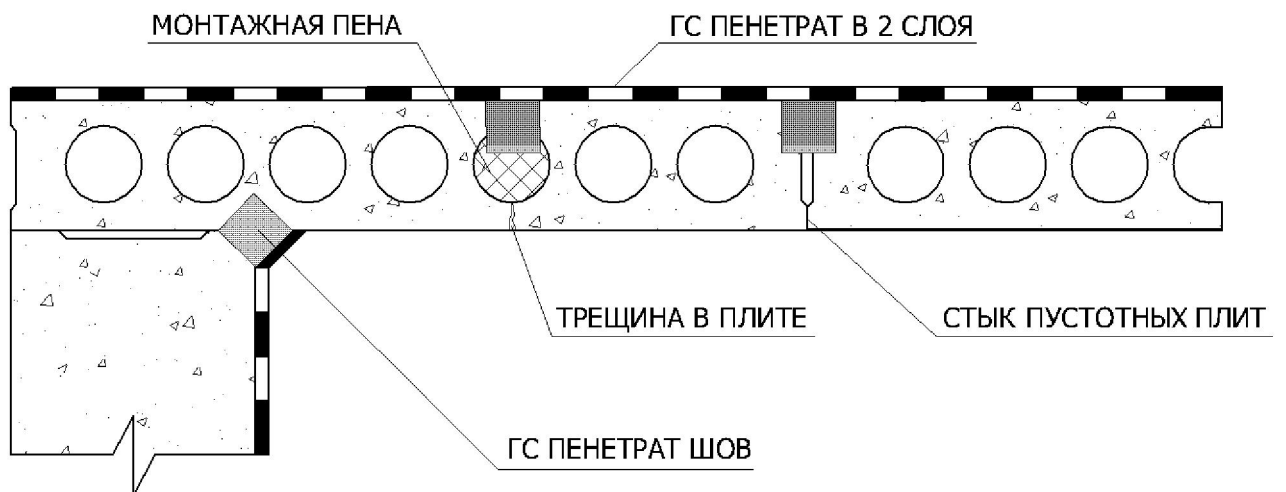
Устройство гидроизоляции существующей конструкции из пустотных плит перекрытия
